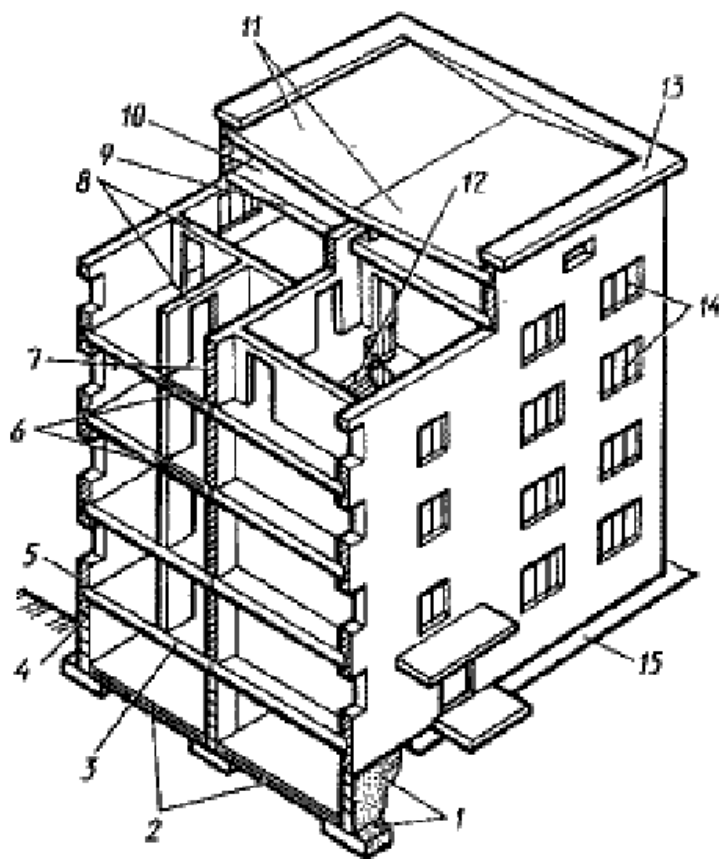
Багатоповерхова будівля традиційної будівельної системи:
